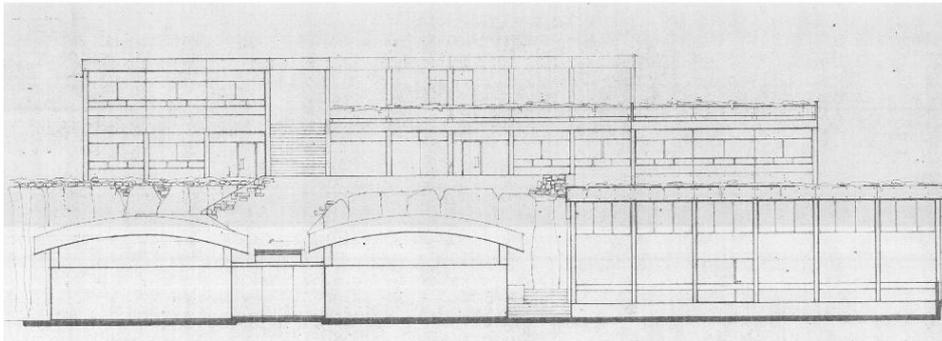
Planos de proyecto de Laboratorios de Ingeniería UCSG
